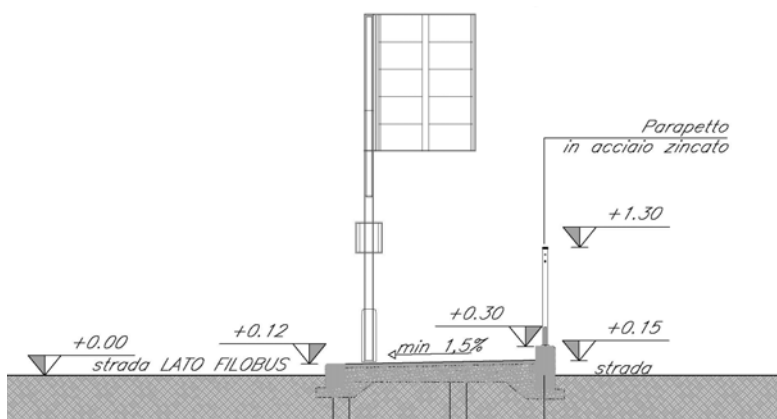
Sezione trasversale tipo banchina T2 (L=2,40 m) e T3 (L=2,10 m)
